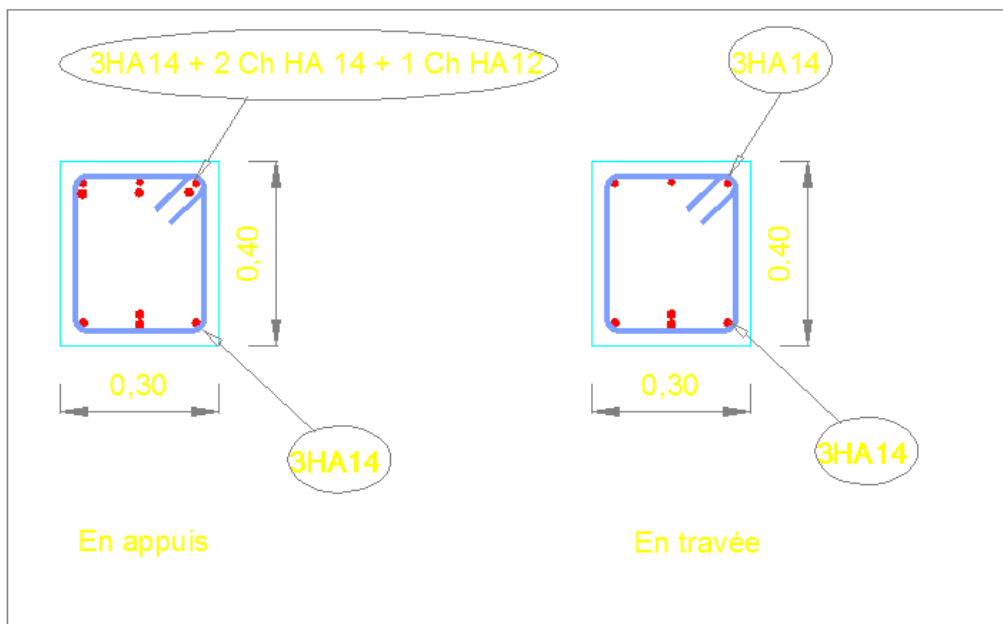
Ferrailage poutre principale 3<sup>eme</sup>, 2<sup>eme</sup>, 1<sup>er</sup> RDC et SSol
